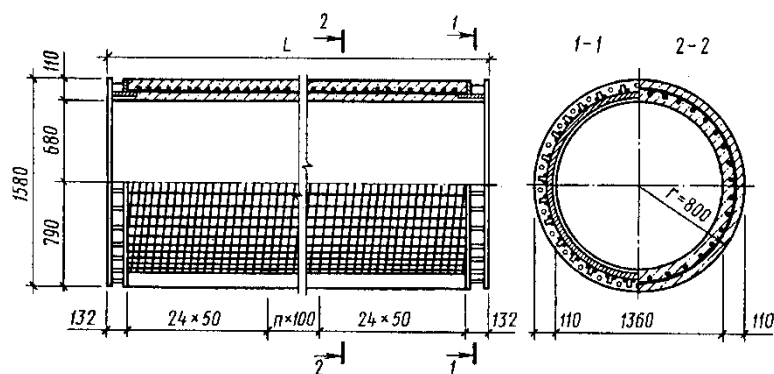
Конструкция типовой оболочки диаметром 1,6м
